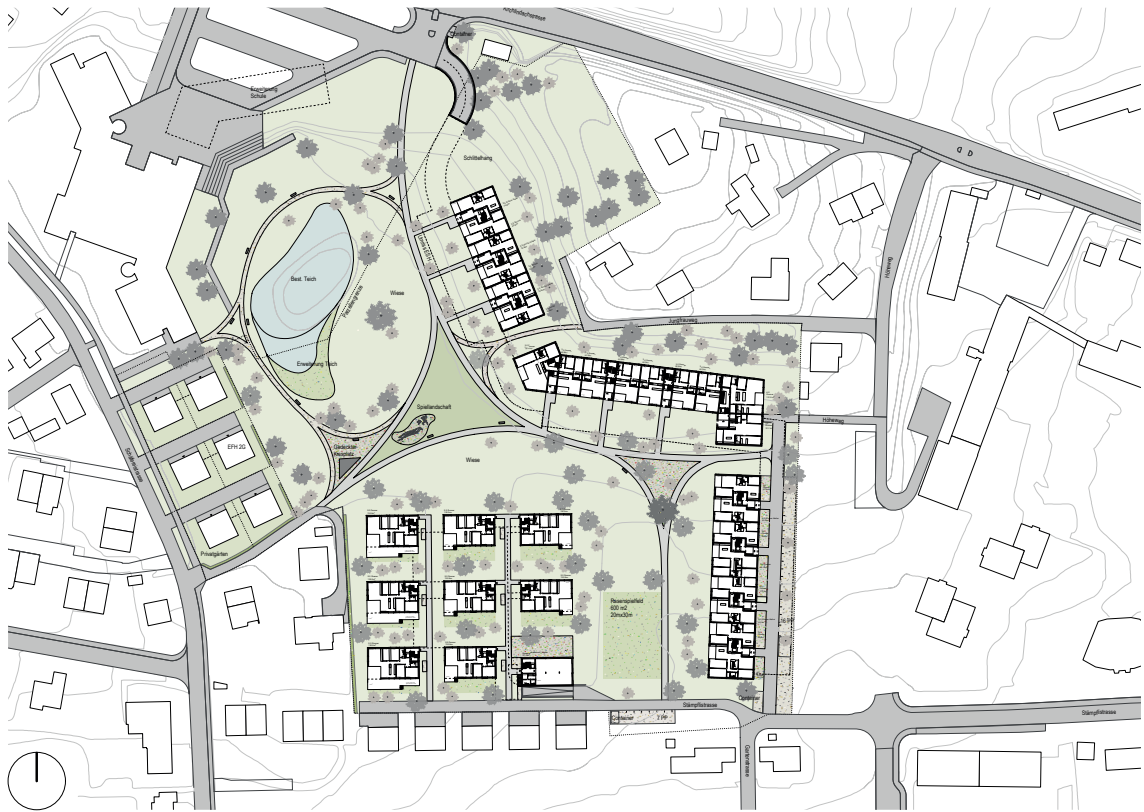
Richtprojekt – Grundrisse Erdgeschoss mit Umgebung
